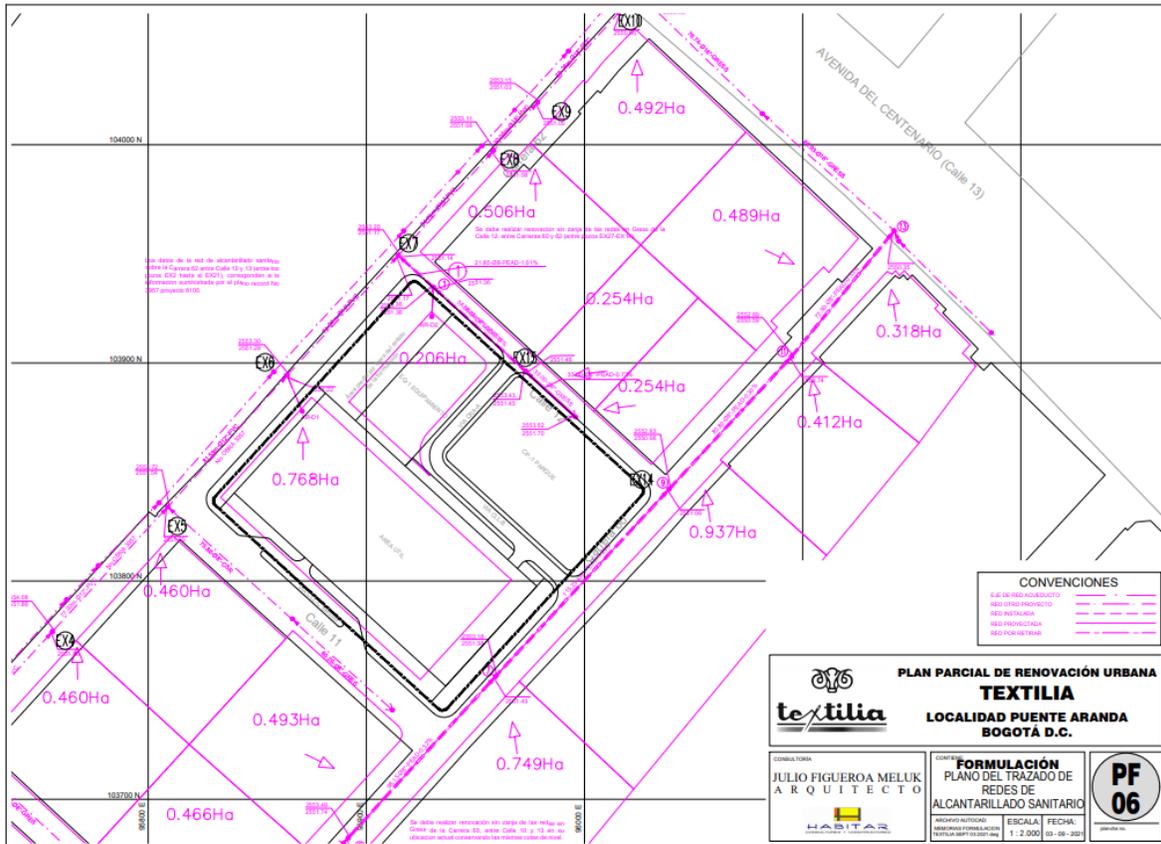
PF 06. Trazado de Redes de Alcantarillado Sanitario
